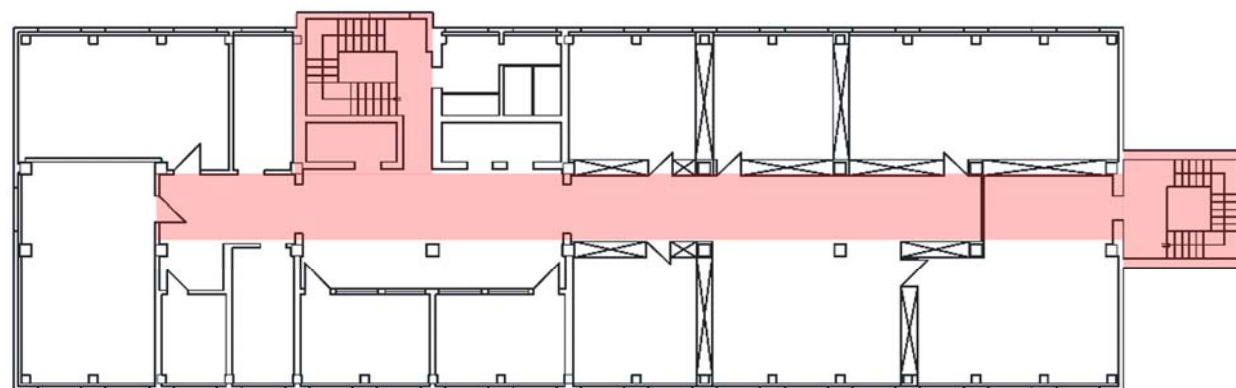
Grundriss Regelgeschoss 2.OG
